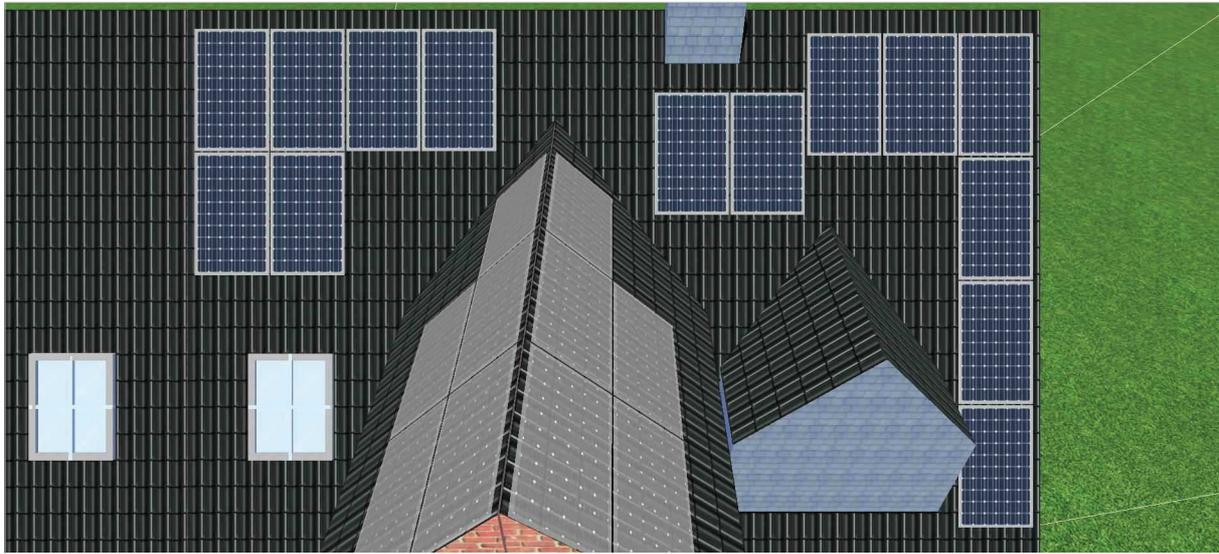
D-Planung zu Gebäude 01-Dachfläche Süd
